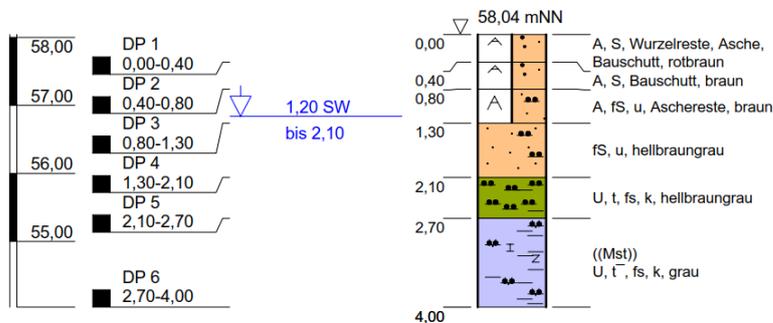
Aufschlussbohrung Rammkernsondierung 47 [18]
